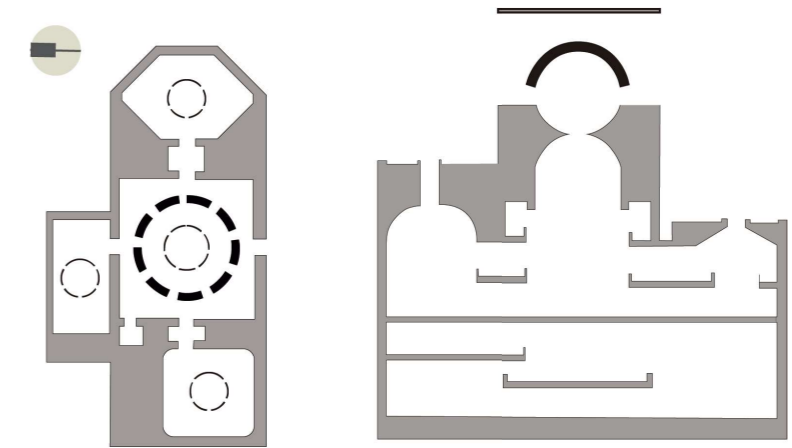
Planta y Secci3n, House of One, Berl3n, Alemania
